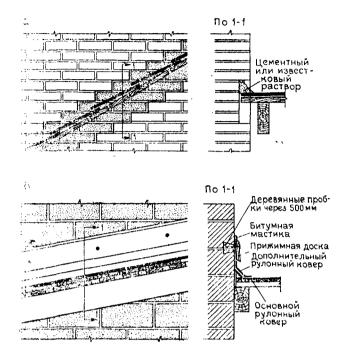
Примыкание кровли к стенам -- с устройством наклонной штрабы; б — с прижимной доской
